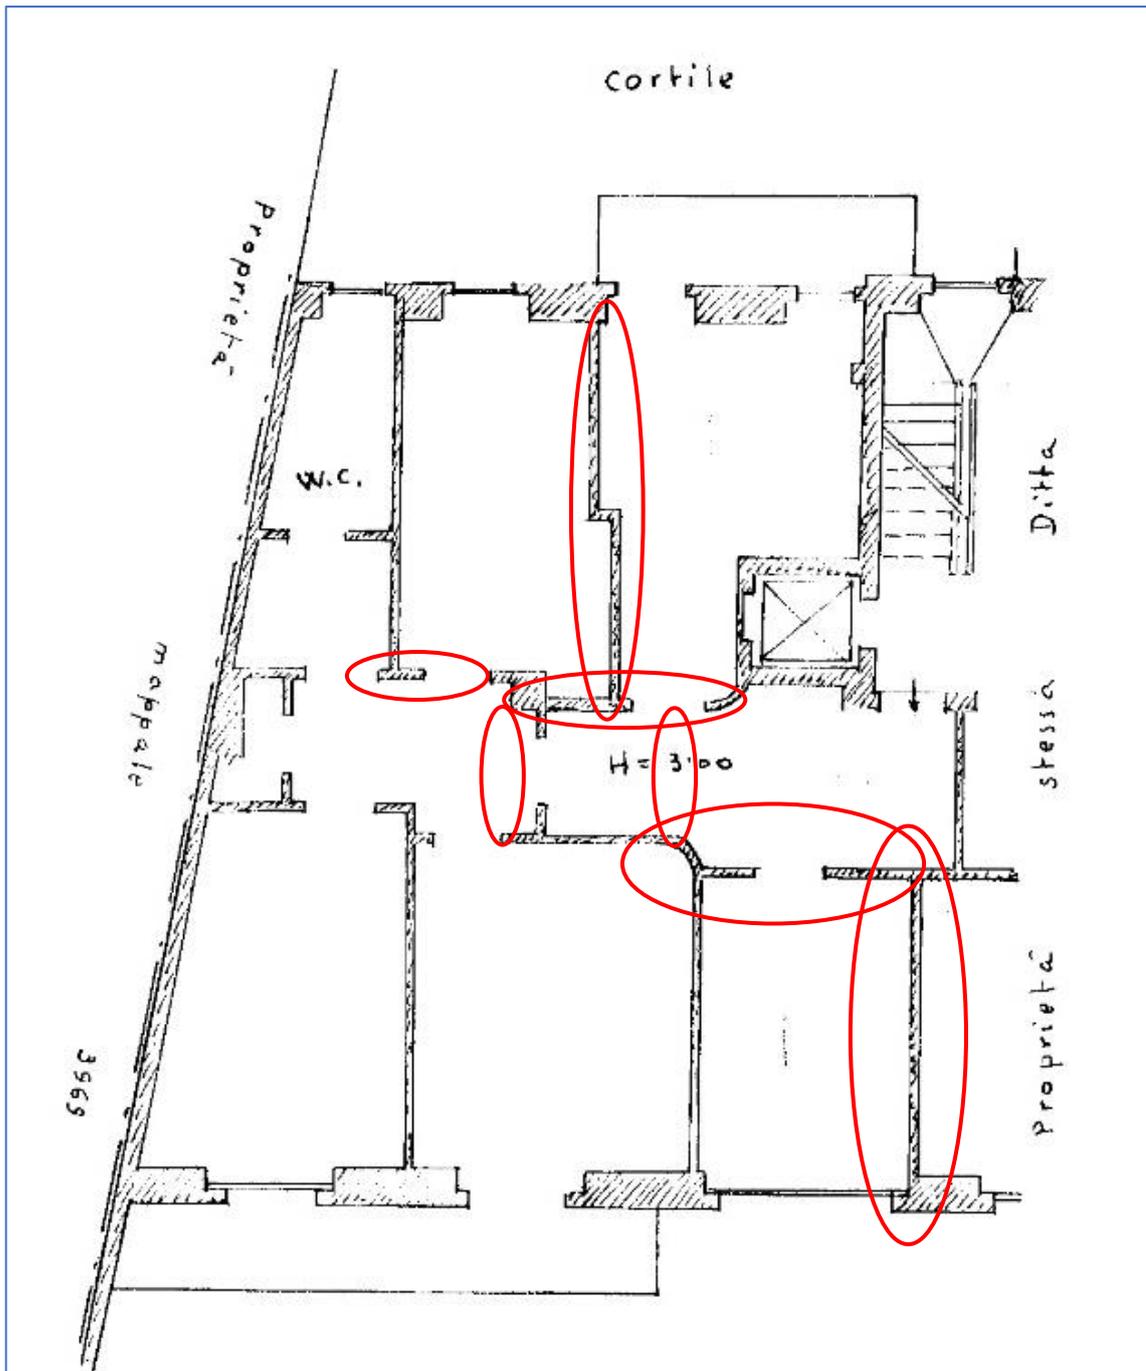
estratto planimetria catastale (in rosso sono evidenziate le zone con le differenze riscontrate rispetto allo stato di fatto)
